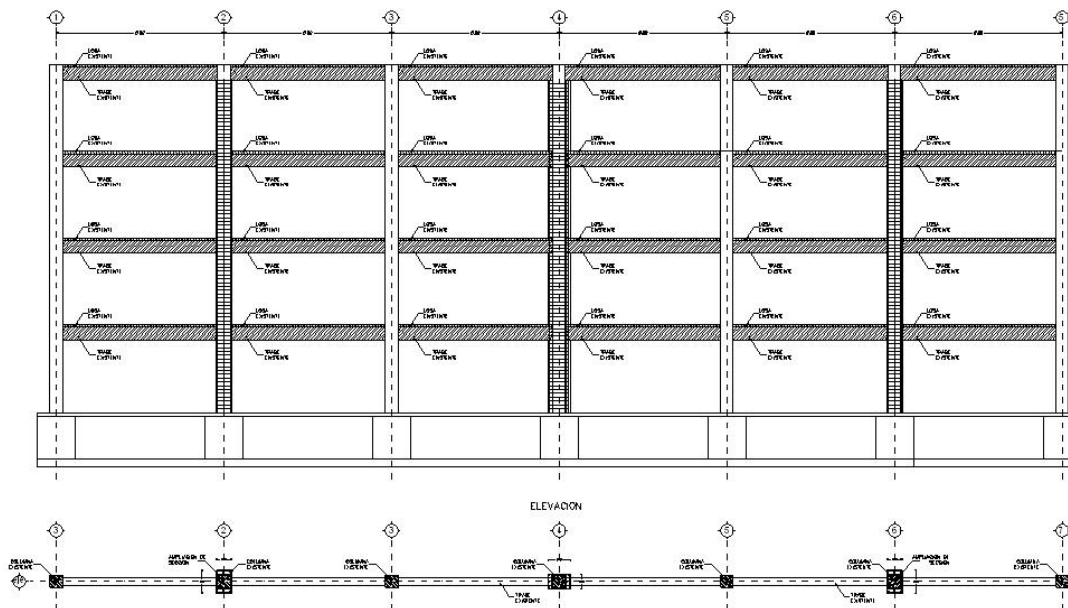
Vista en elevación de los ejes C, D y E que se propone reforzar
